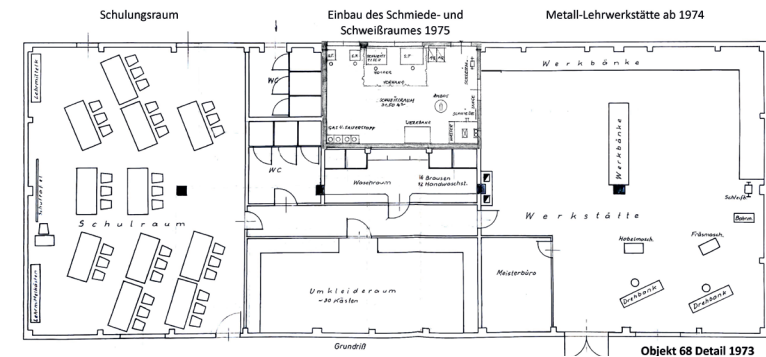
Grundriss Metall-Lehrwerkstätte ab 1974 im Objekt 68
